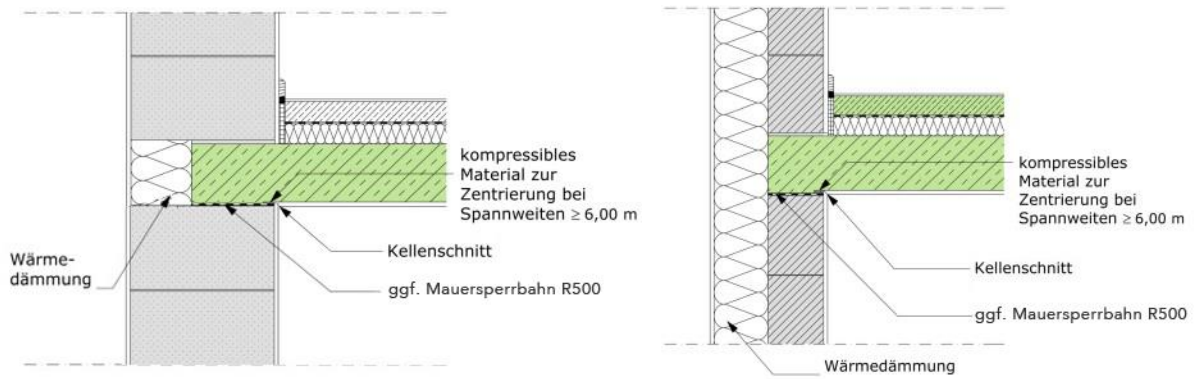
Beispielhafter Aufbau eines Wand-Decken-Knotens:
